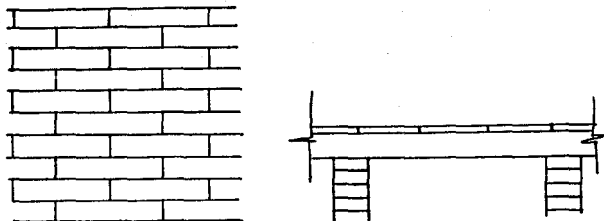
VIGA COMPUESTA DE MADERA Y CONCRETO.
